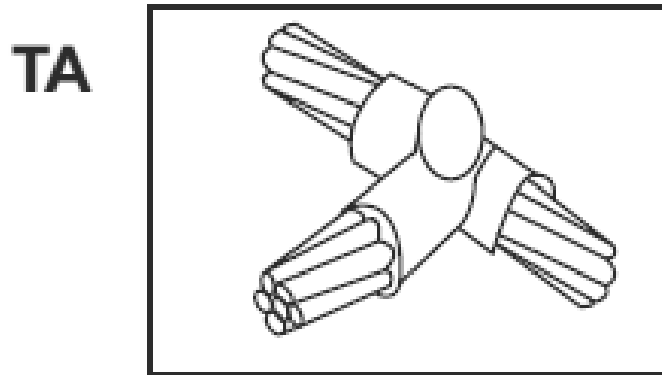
Tipos de soldadura de cable a cable.
